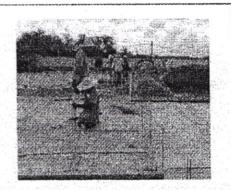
Fixação das barras de ancoragem à fundação com adesivo epóxi
